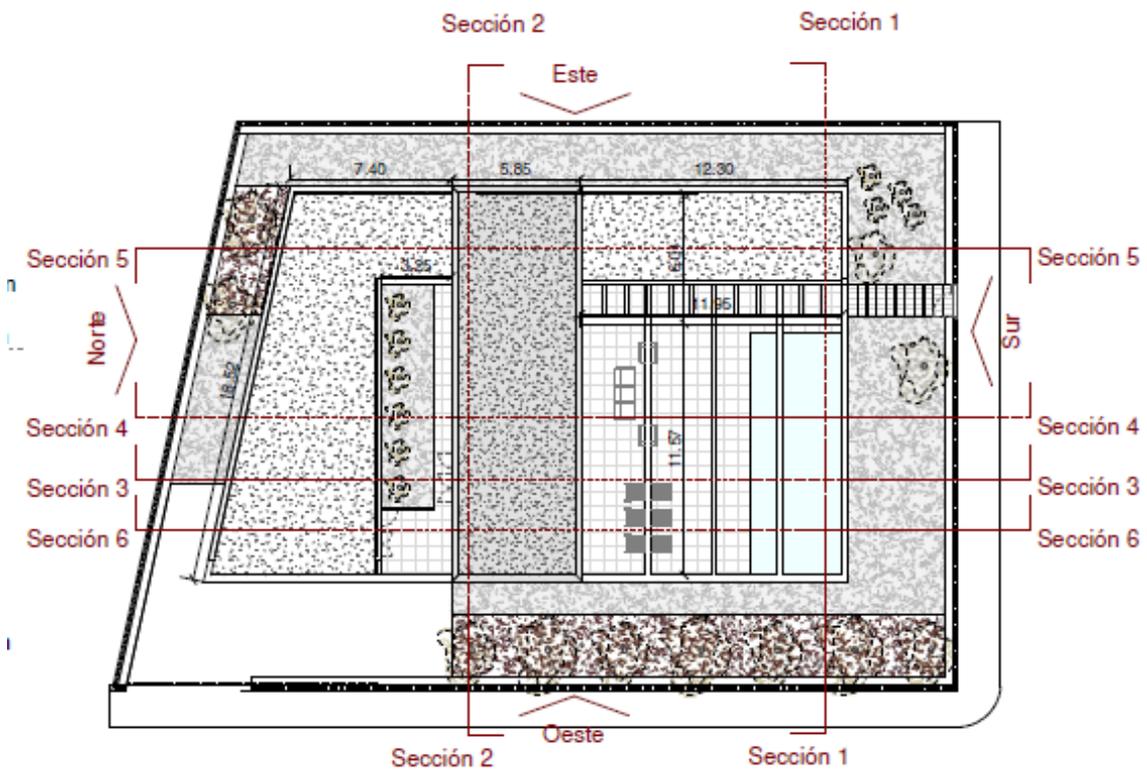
Planta Aérea. 2019. Planos del Proyecto
